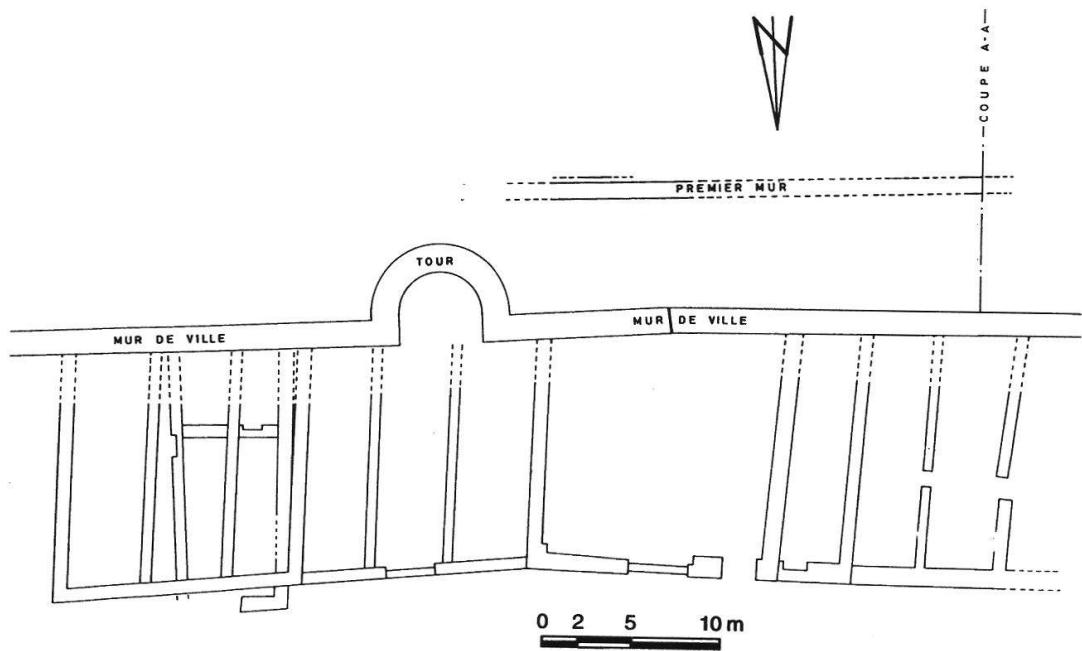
PAYERNE – Mur de ville. Plan général des investigations vers la tour Ronde. (Dessin C. Grand, Archéotech SA)
